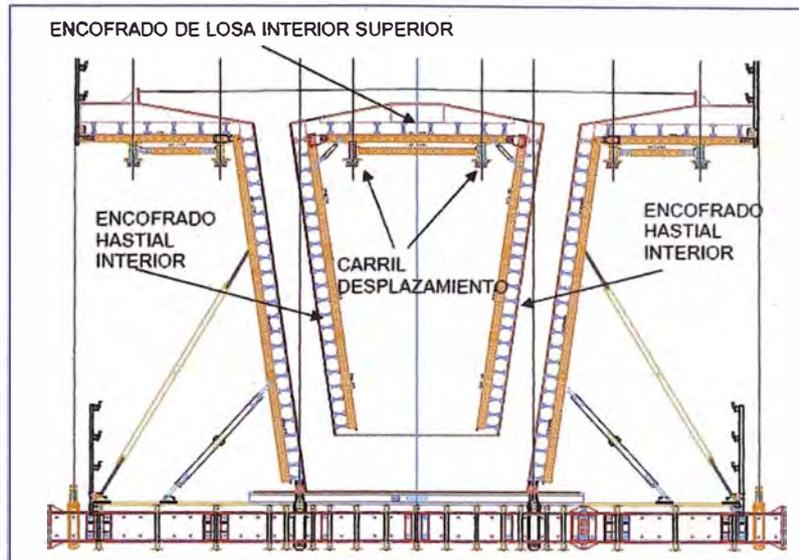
Vista sección encofrado interior, exterior y fondo - Fuente: Elaboración Propia
